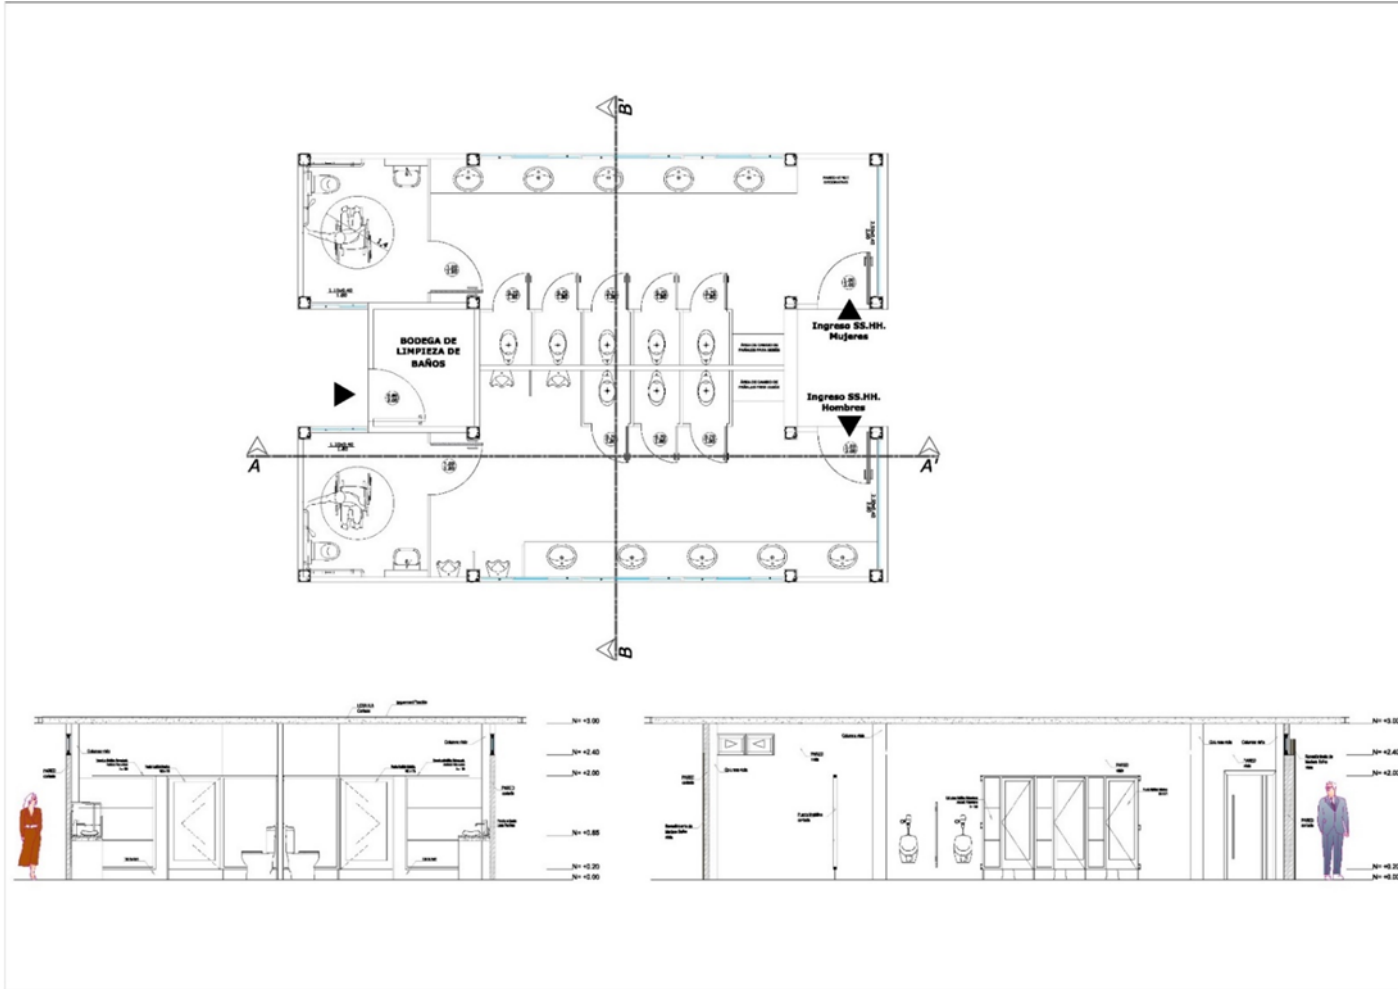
Detalle en Anexo 13. Elaboración: Propia.
